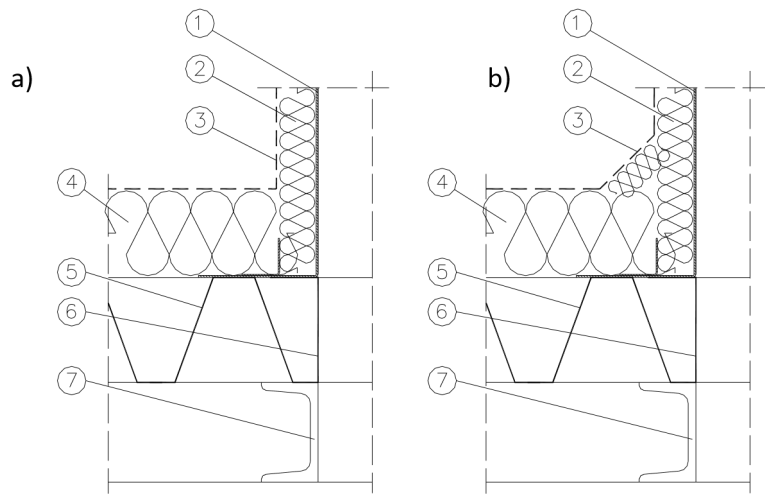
Стальное основание на стальной конструкции (а – обработка мембраной, б – обработка рубероидом)
